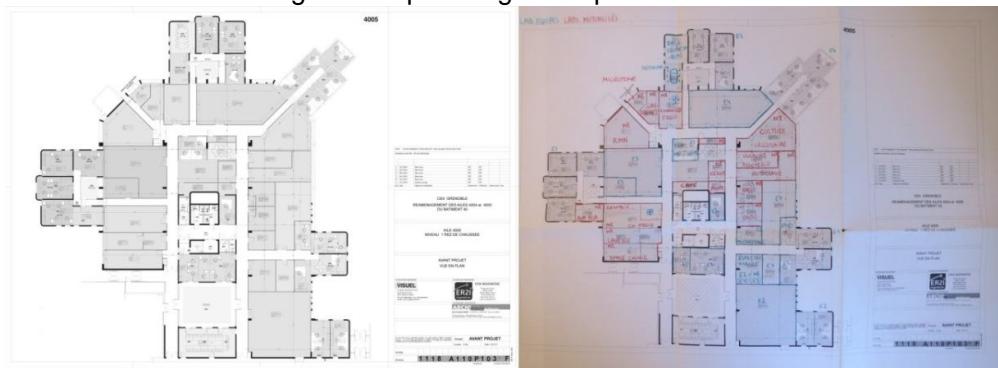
vue en détail de la partie du plan original et du plan modifié
